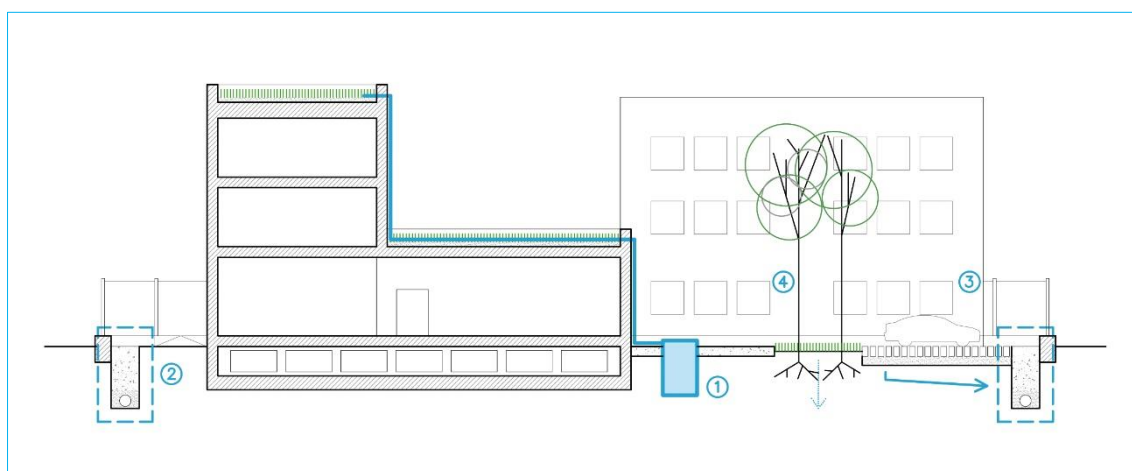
SUDS. Esquema en sección. 1 cubierta verde y aljibe, 2 zanja drenante, 3 pavimento permeable, 4 franja de vegetación.
